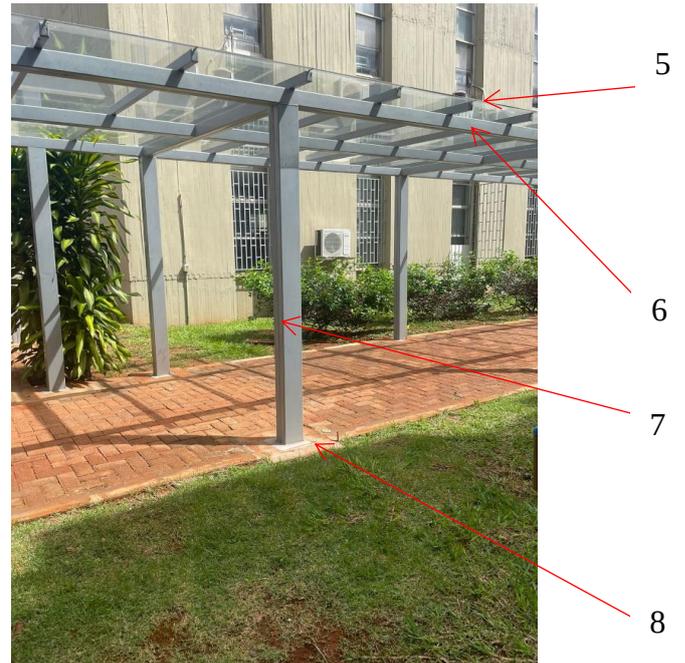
Foto retirada da pérgola da praça existente demonstrando composição de pilares, vigas e terças.
